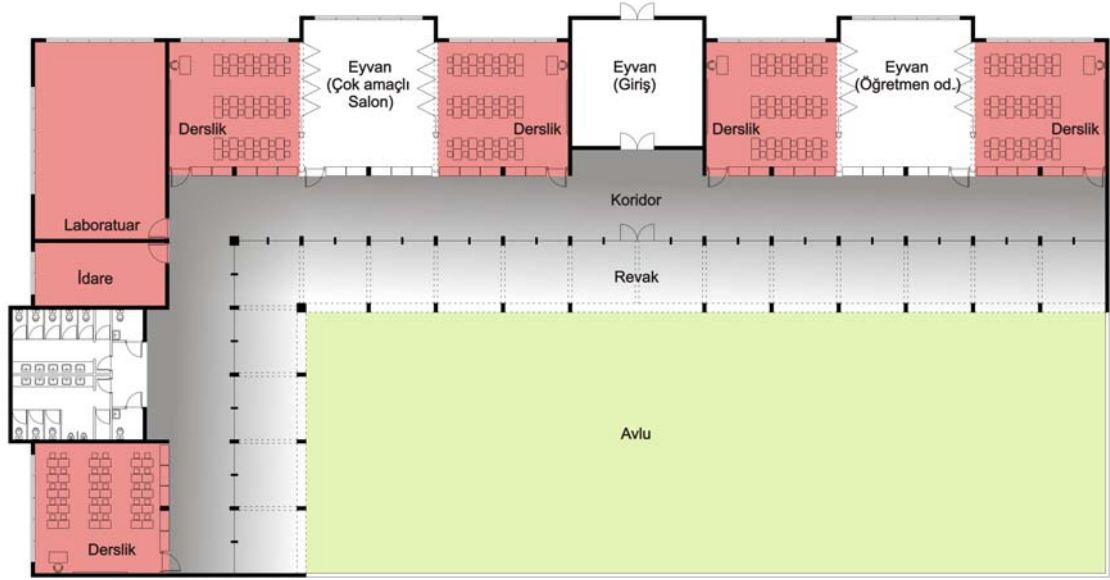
Dört derslikli ilköğretim okulu plan şeması
